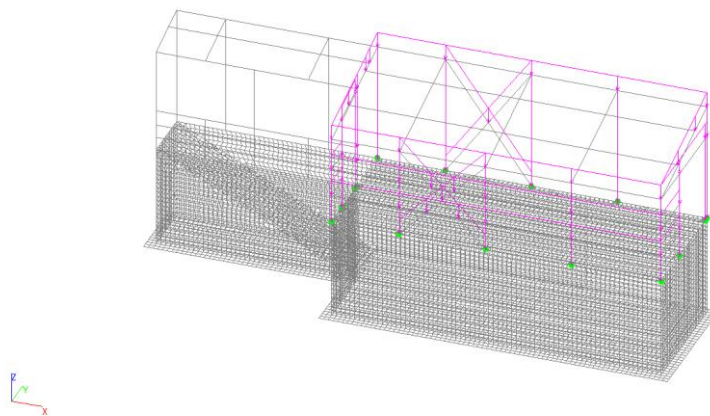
Расчетная модель монолитной лестницы по грунту, загруженная весом ограждающих конструкций (вариант №2)
